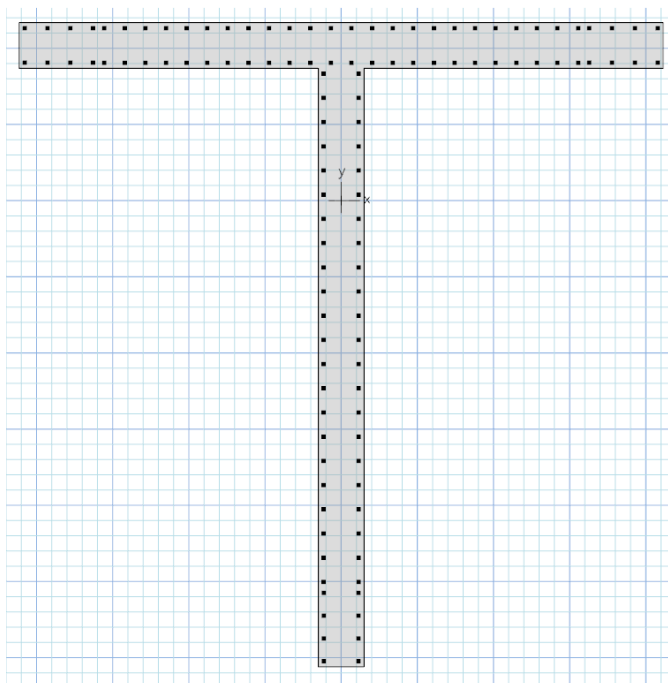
19: Modelación de muro en T de concreto reforzado en spColumn
